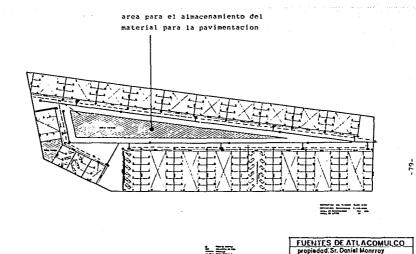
AVANCE EN LA CONSTRUCCION DEL ADOQUINADO
